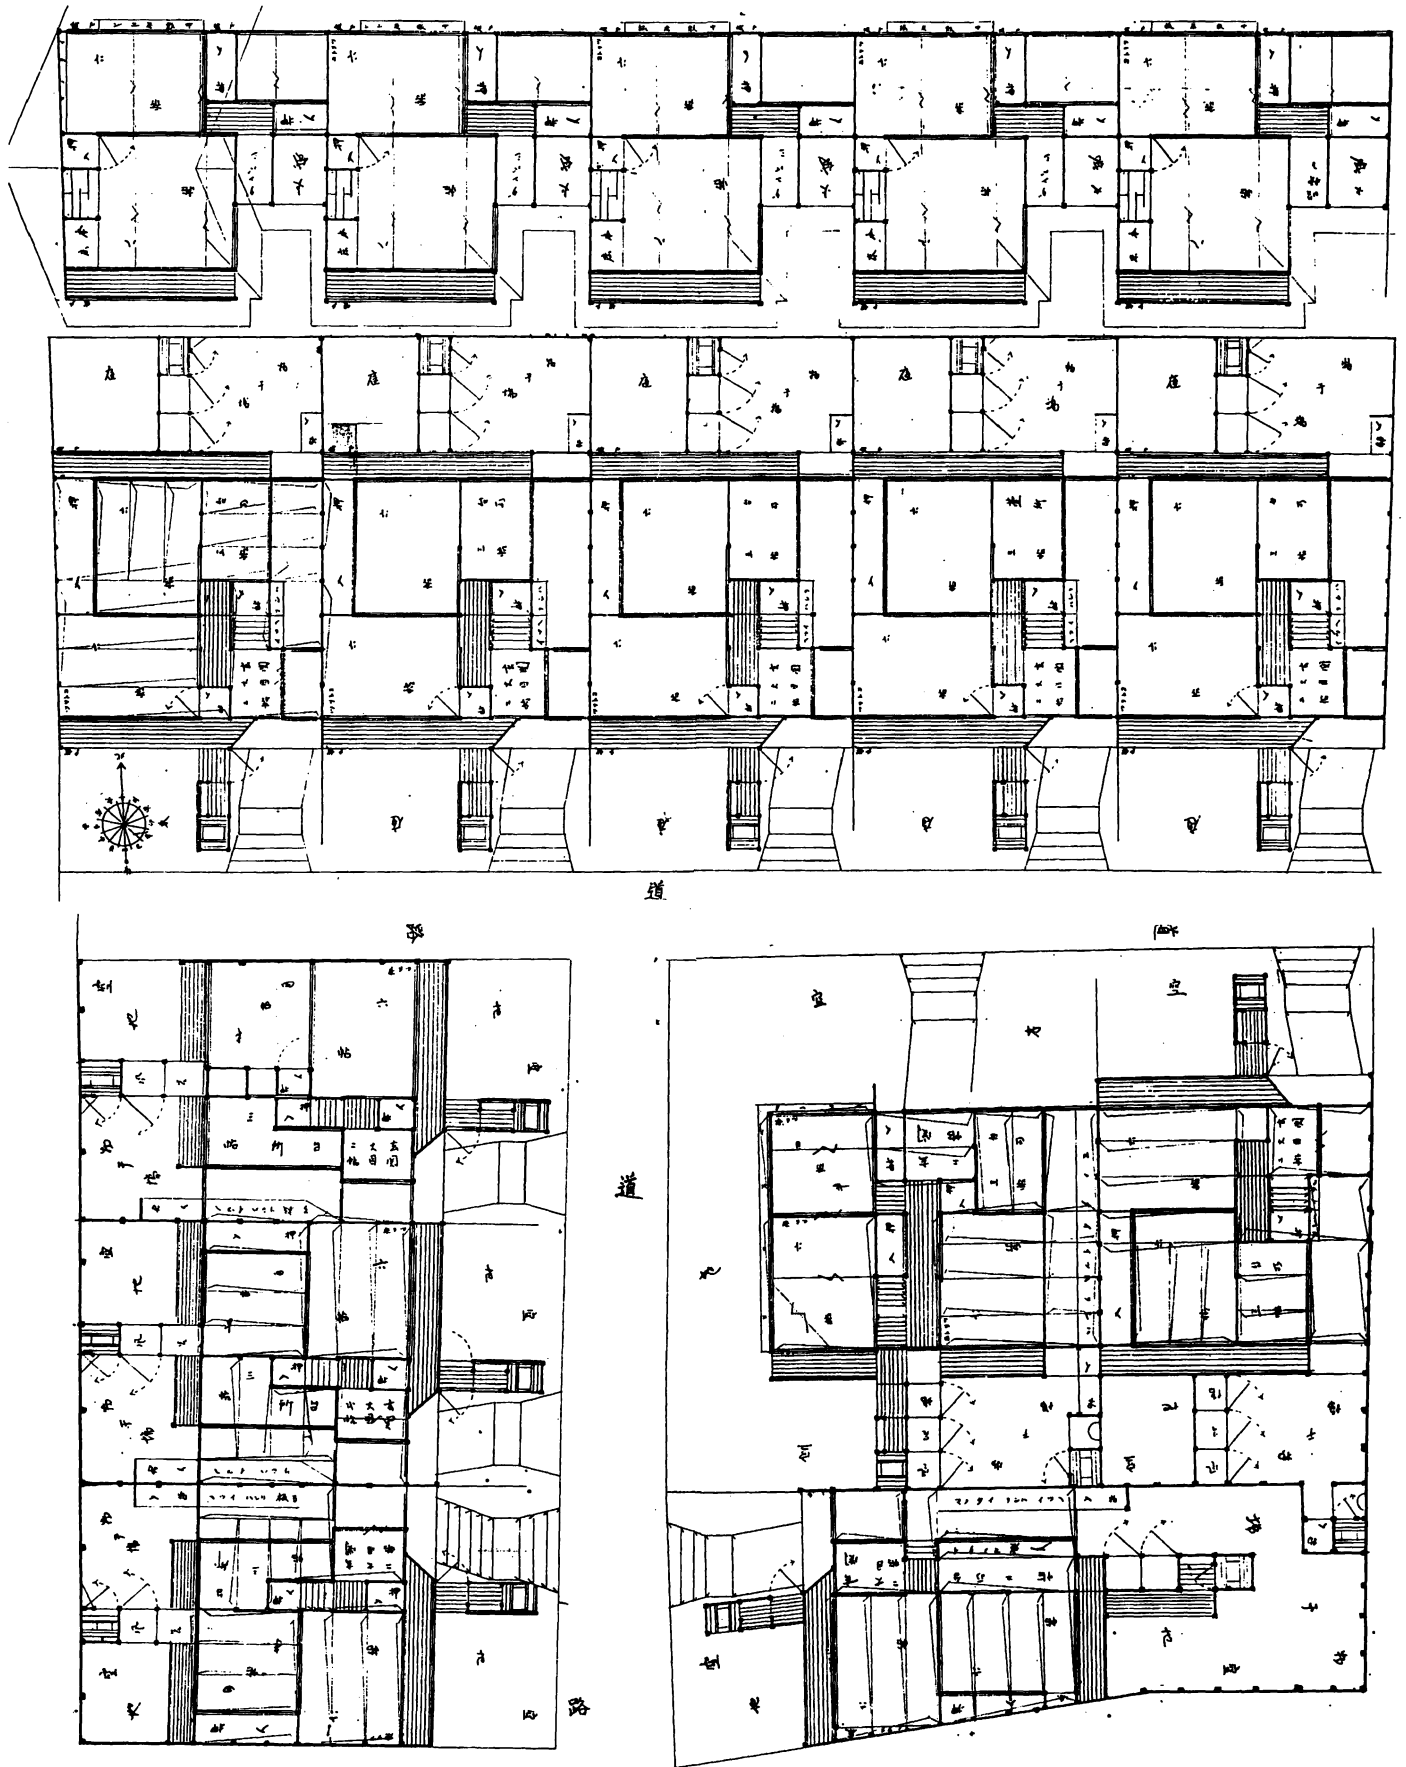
開発当初の家屋の平面図 (6~8・12~19番) (上村家蔵)
